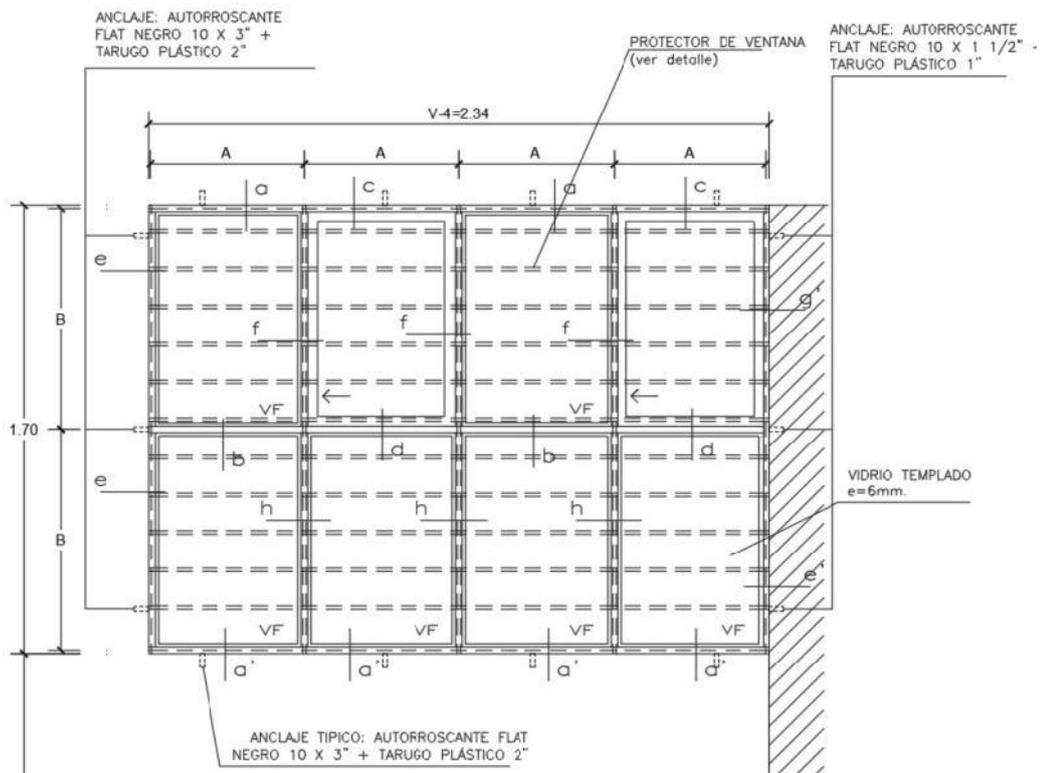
Plano de detalles de ventanas identificado en el plano D – 03 de la ventana V-4
